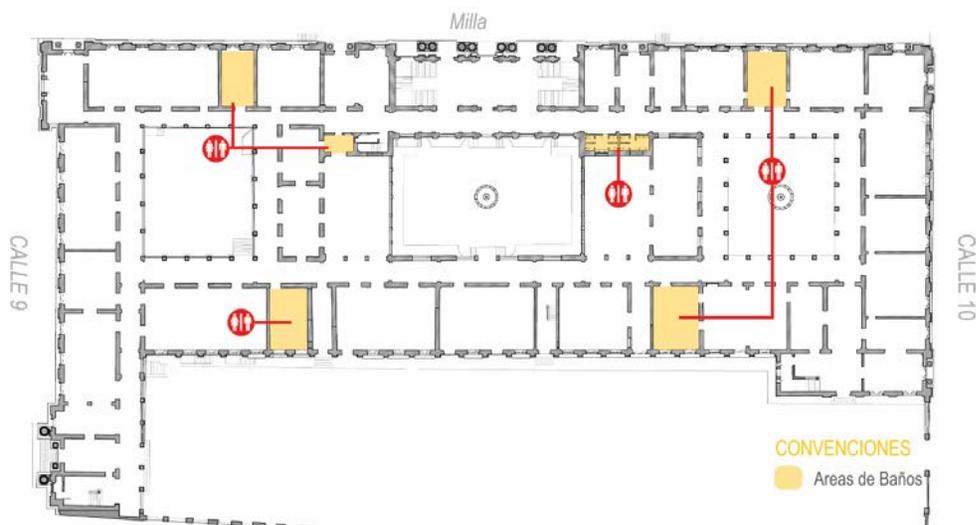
Esquema de ubicación de baños Planta Primer Piso
